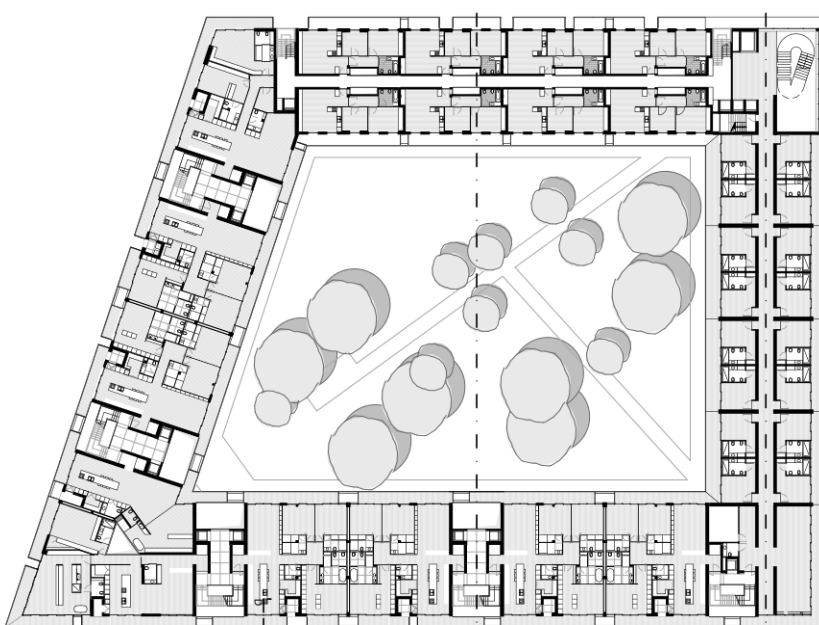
PLANTA DO 4º E 5º PISO (AUTOR, 2015)
